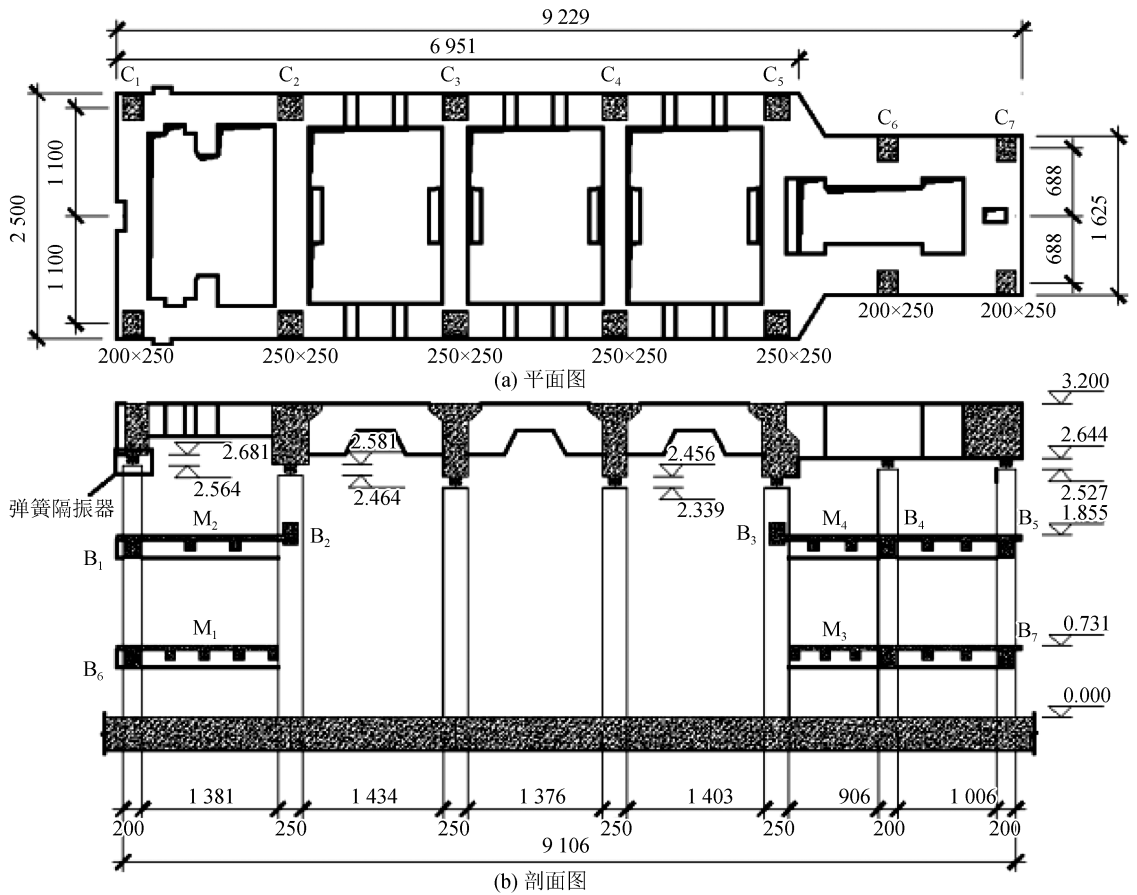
模型平面和剖面图(尺寸单位 mm,标高单位 m)
